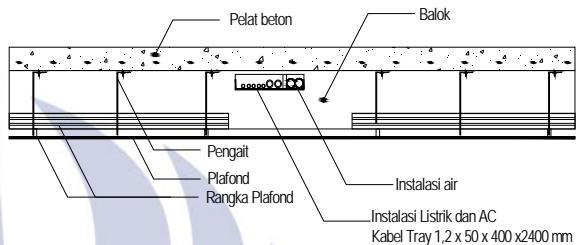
Instalasi dibawah balok beton tertutup plafond
